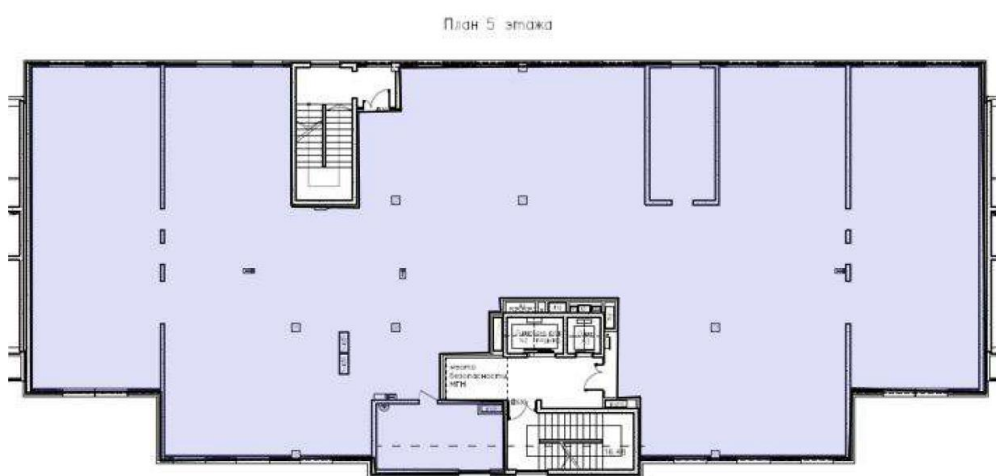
План 5 этажа БС-13 ЖК URAL
